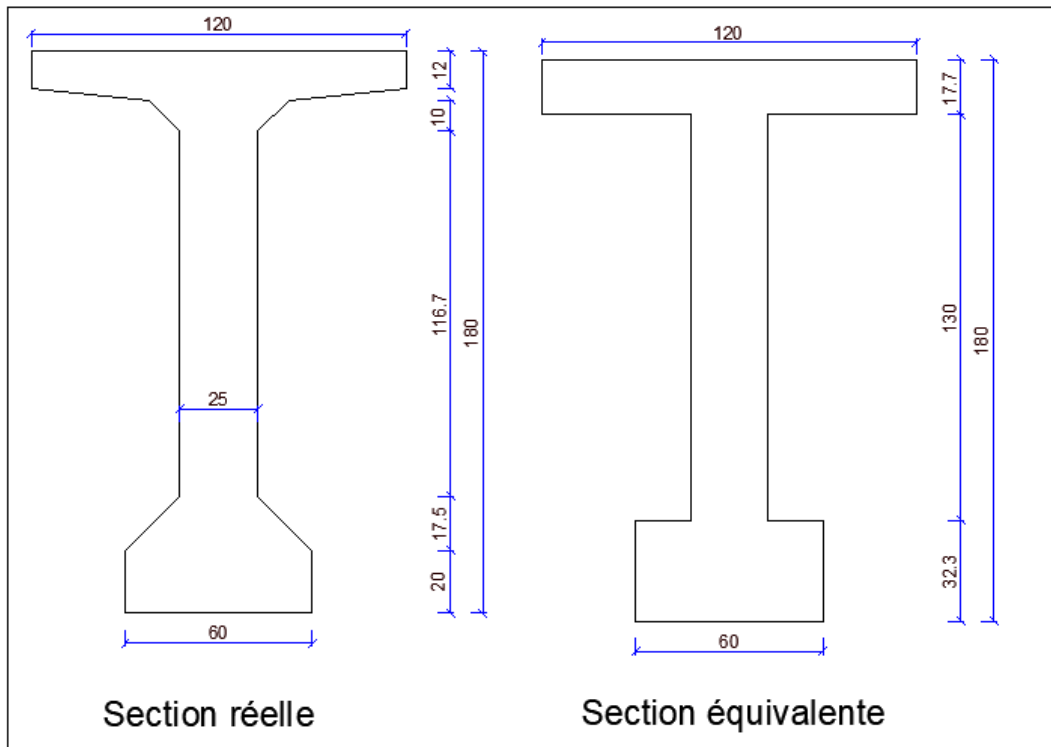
Schéma représente La section équivalente de la poutre
